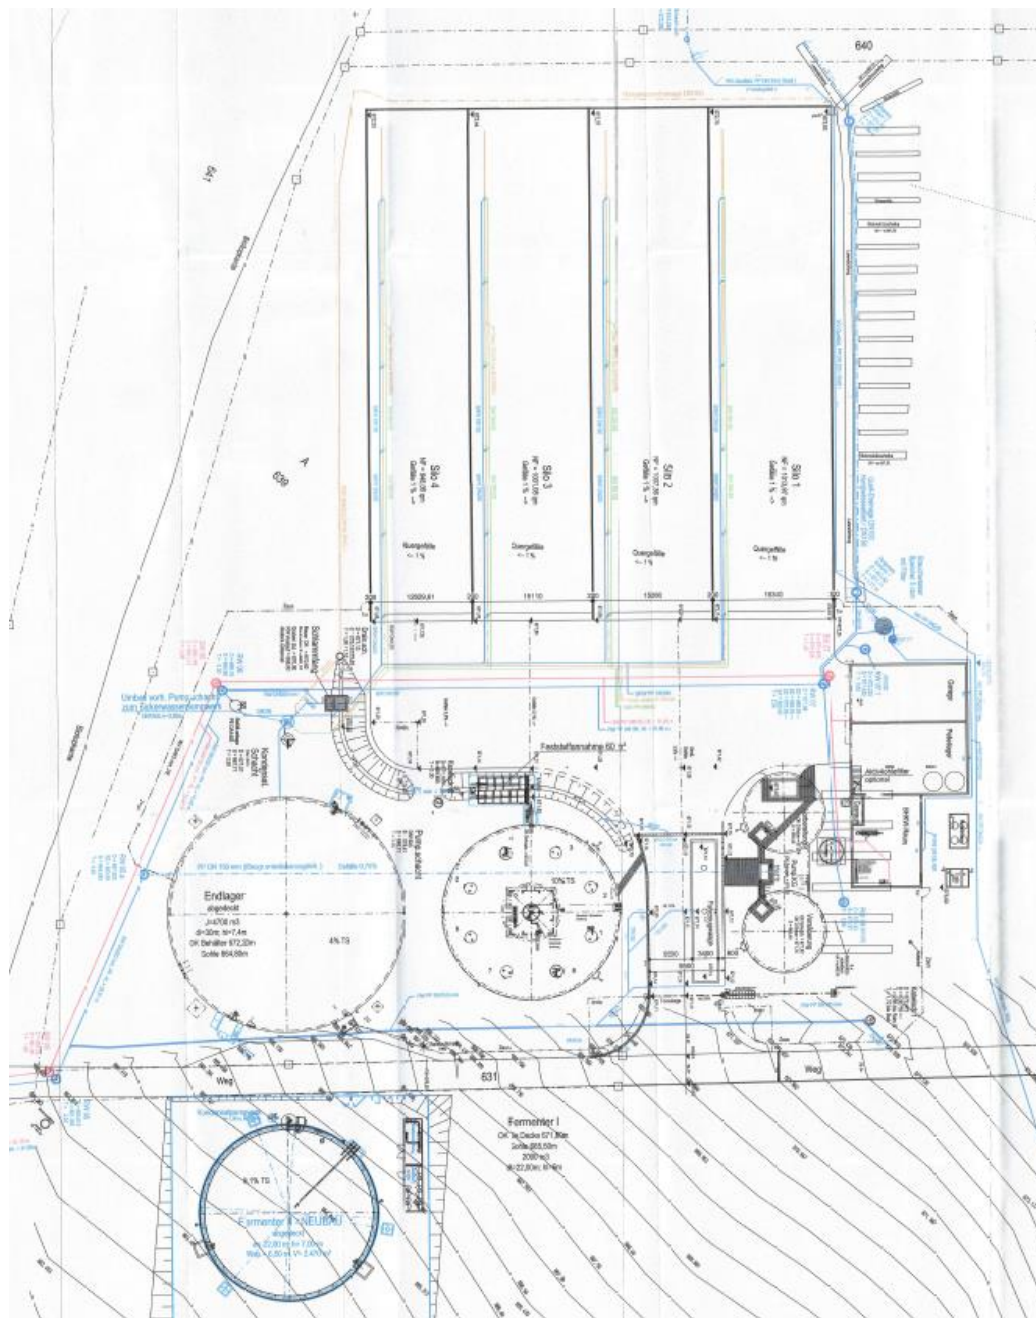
Lageplan des Betriebsbereichs (Quelle: Betreiber)
